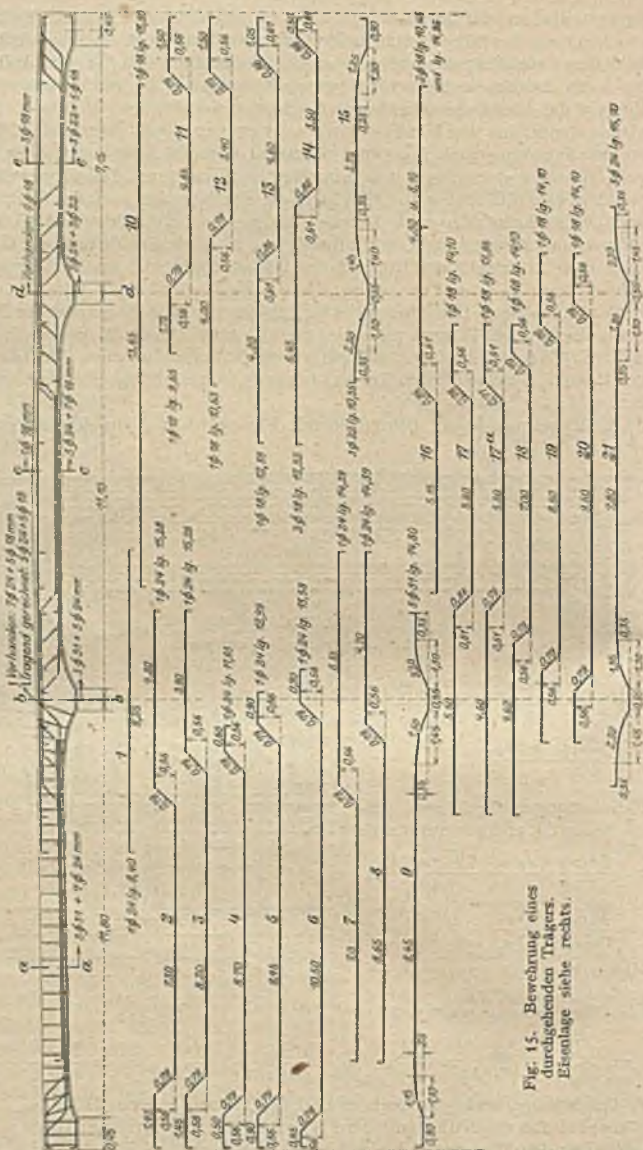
Bewehrung eines durchgehenden Trägers. Eiseneinlage siehe rechts.
